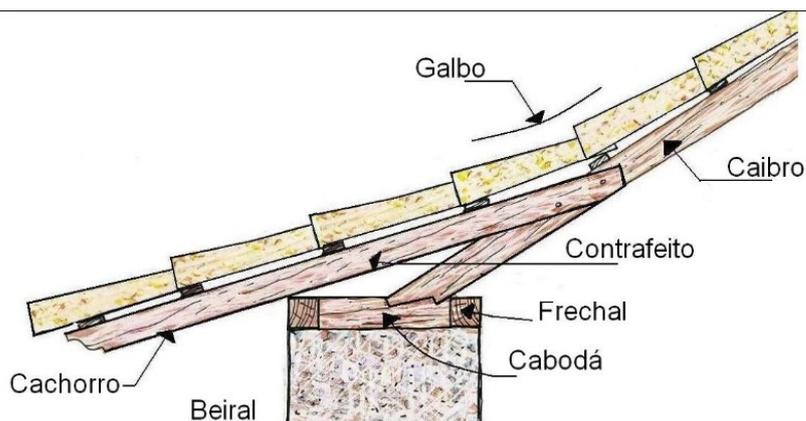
Elementos do beiral de caibro armado. Fonte: Coisas da arquitetura
